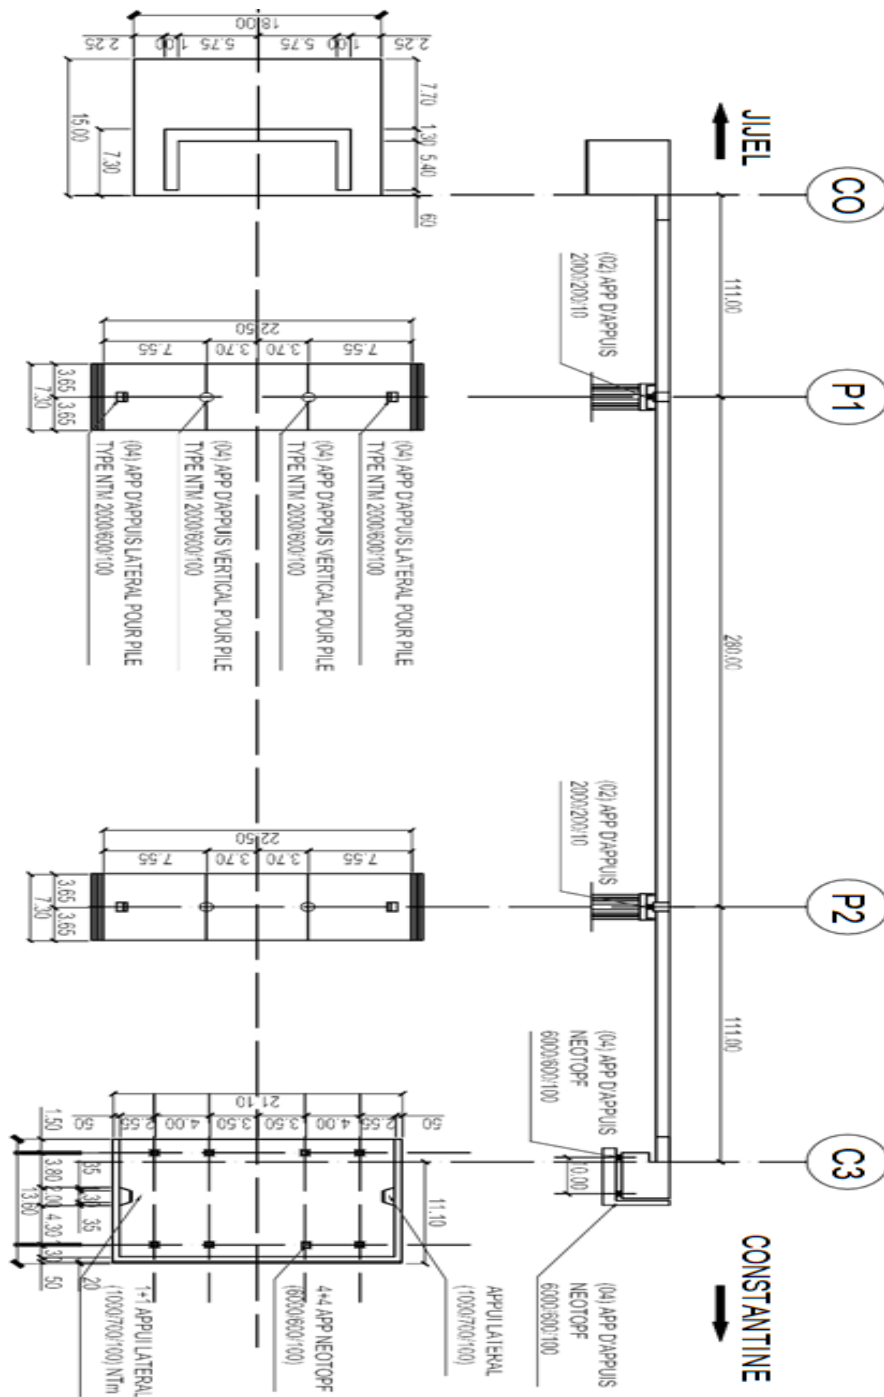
Coupe longitudinale et vue en plan du pont de Mila
